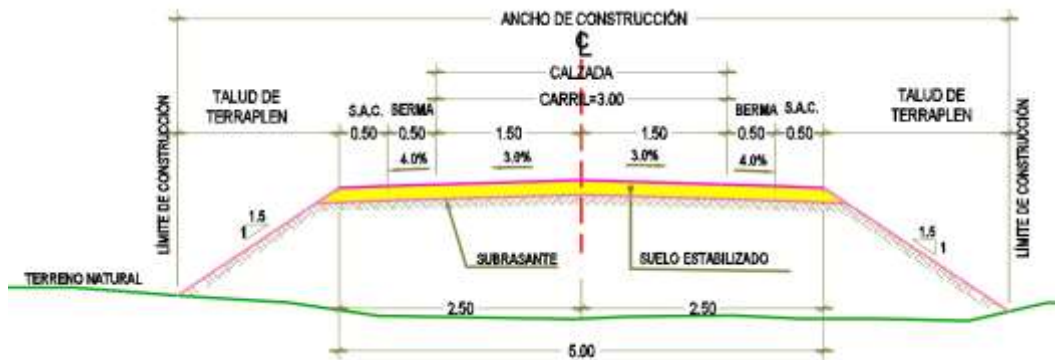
Sección típica en relleno. Fuente: plano de Secciones Típicas.
